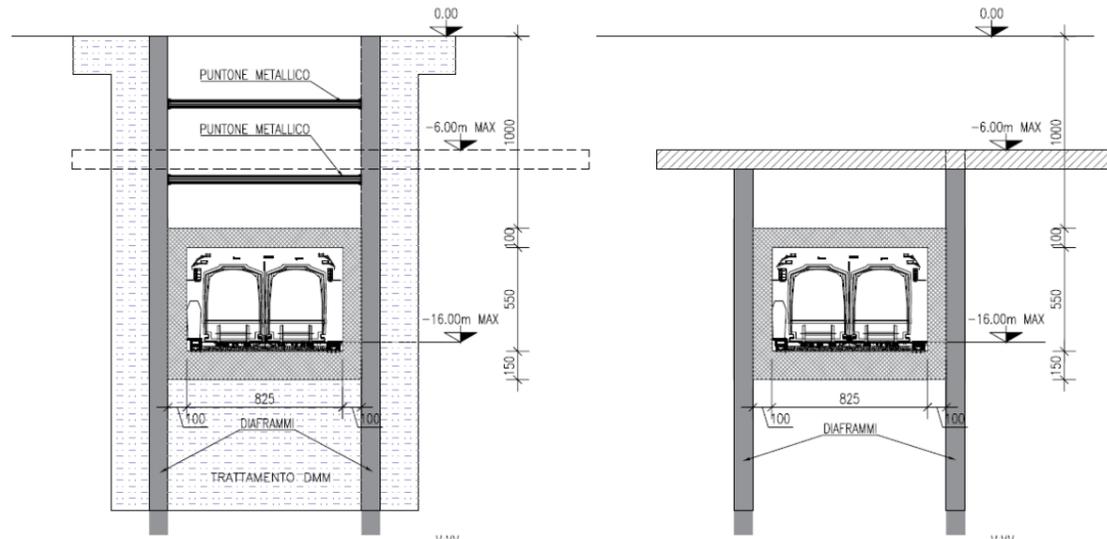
Sezione tipo nelle argille sensive in corrispondenza del terminal
